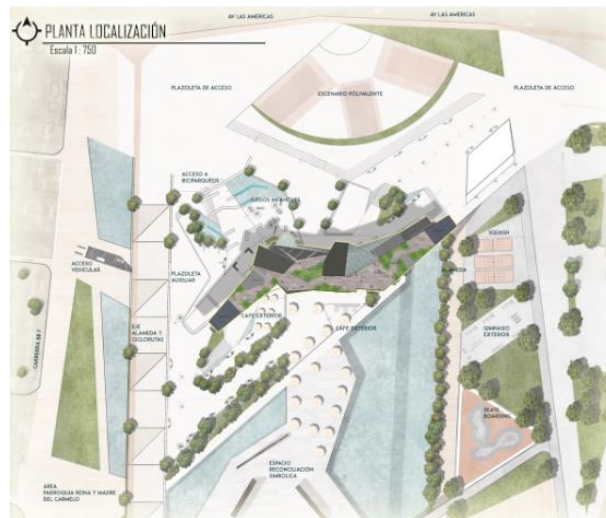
Planta de localización de proyecto arquitectónico EQUILIBRIUM. Elaboración propia, 2008.
